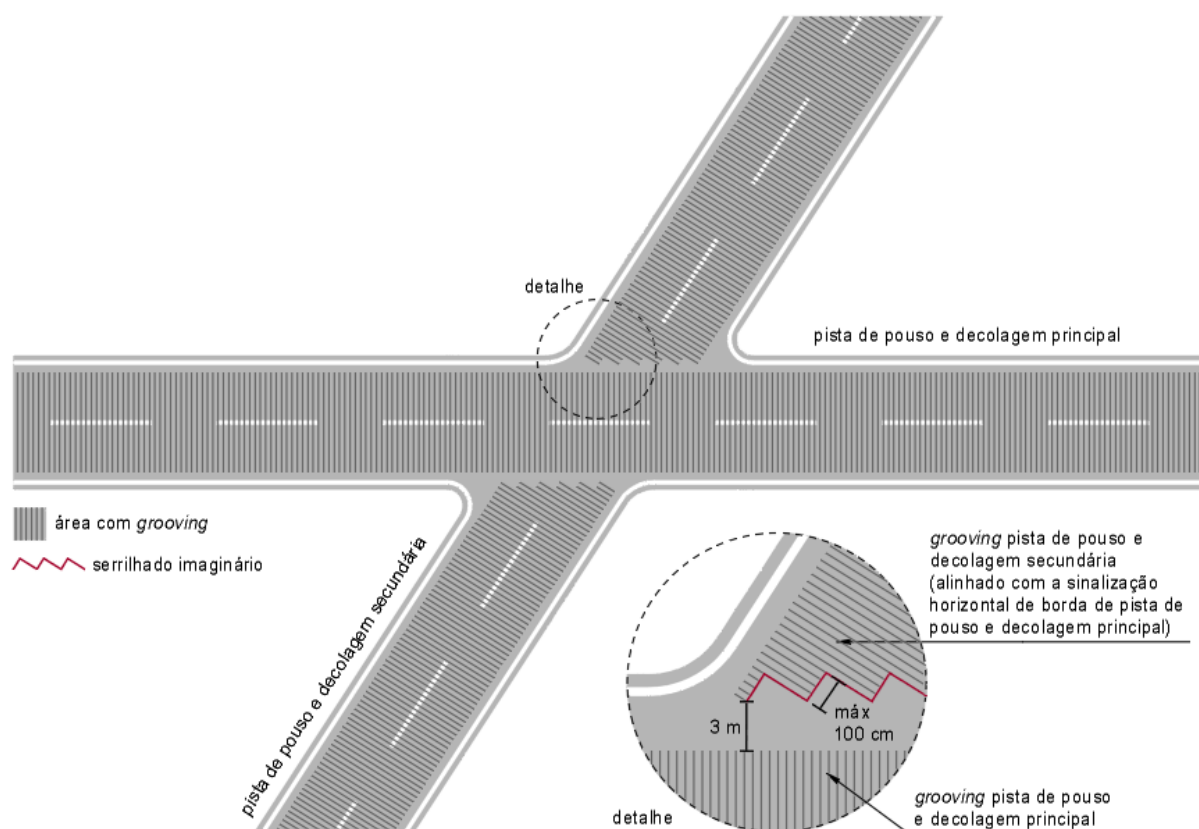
Ranhuras em interseção entre pistas de pouso e decolagem.
